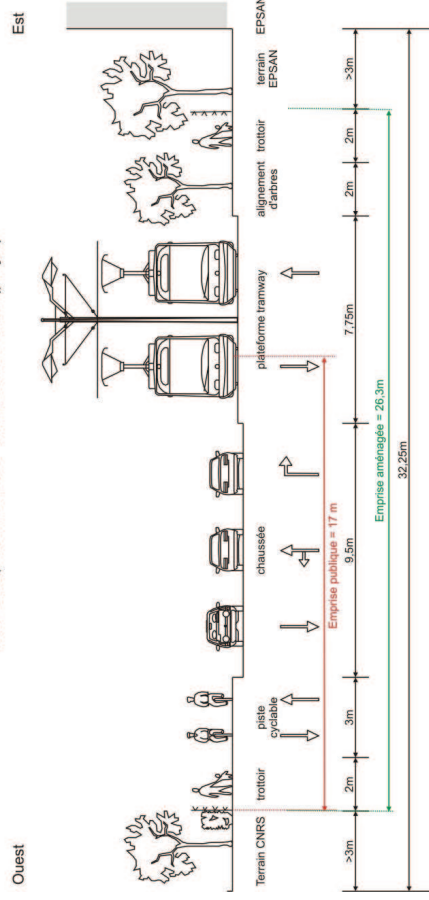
Situation projetée (coupe 14 bis) sur la rue Becquerel carrefour EPSAN
